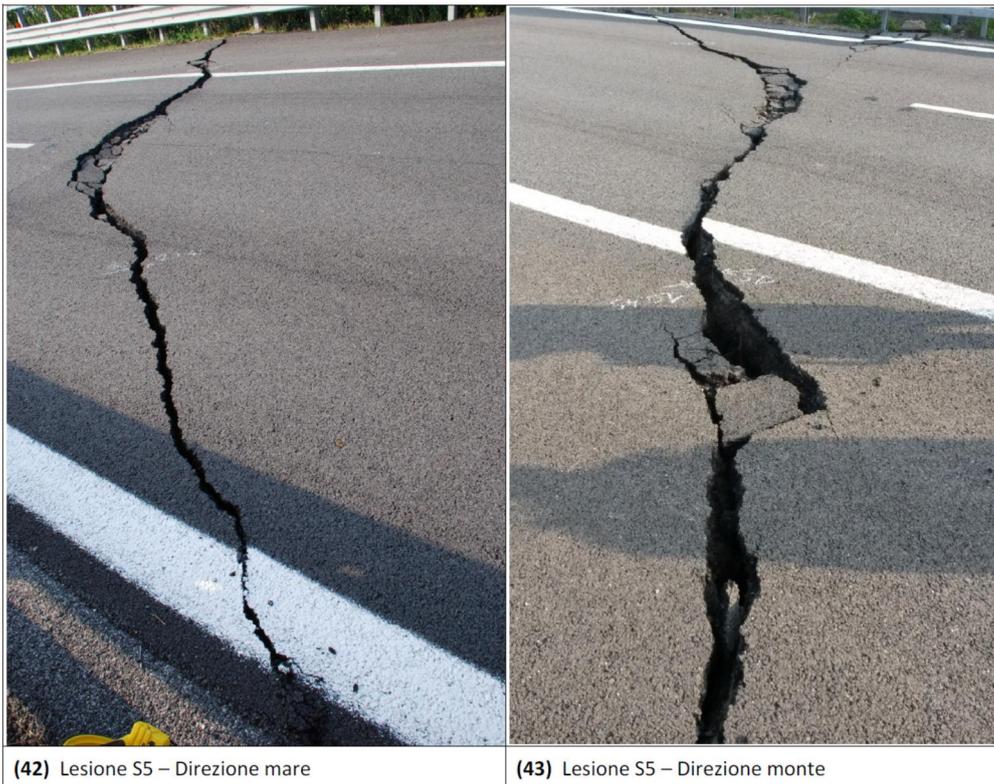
Viadotto Cacchione – Riattivazione 2015: Lesioni nella pavimentazione stradale nel tratto di rilevato/mezzacosta compreso tra il Viadotto Cacchione ed il Viadotto Marinella (Lesione “S5” in Carreggiata Nord a 55m circa dalla Spalla Bari del viadotto)
